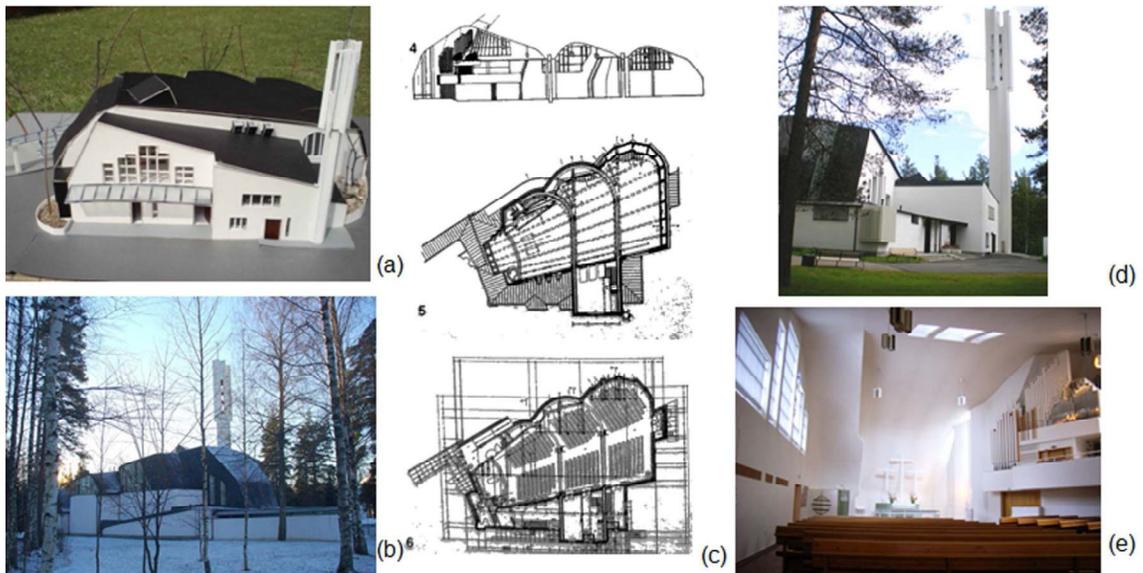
Alvar Aalto, Iglesia Vuoksenniska, Imatra, Finlandia, (1956-1959): (a) Maqueta, (b) Vista exterior, (c) Sección longitudinal, Planta de la galería del órgano con la construcción del techo en línea de punto, Plano de la planta baja, (d) Detalle de acceso, (e) Interior.
